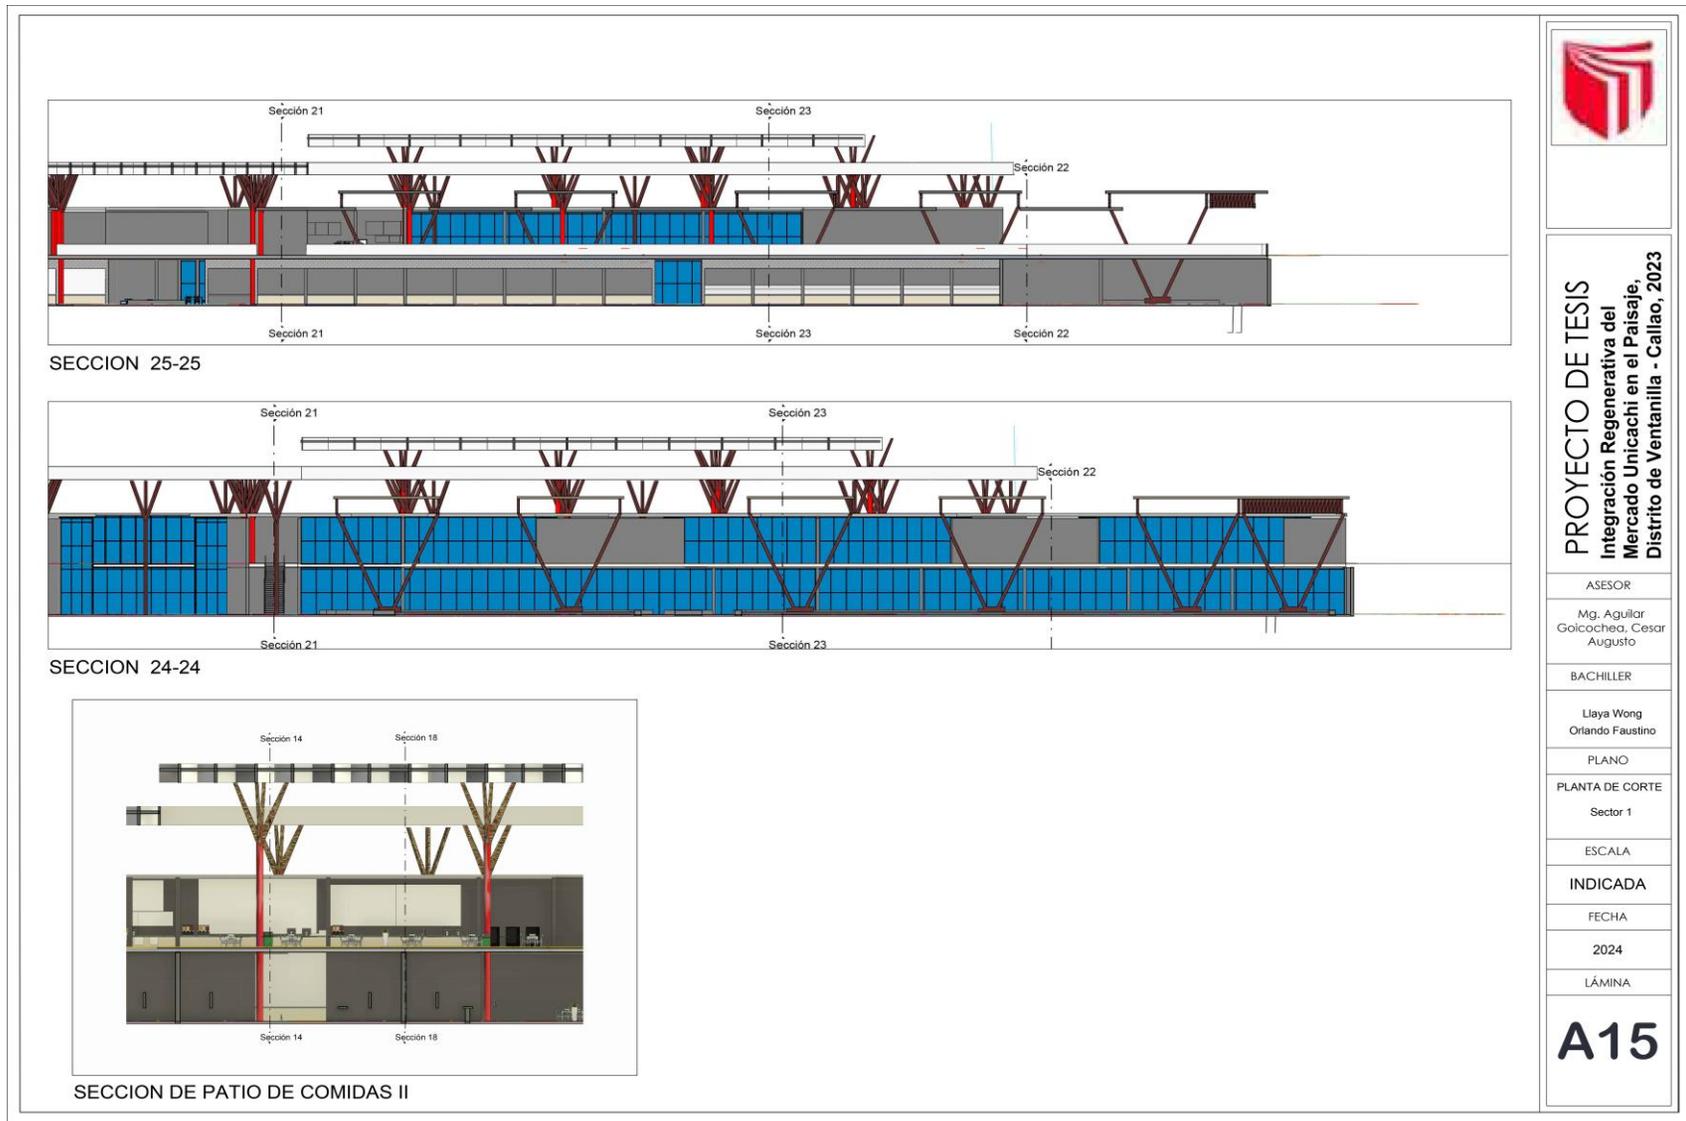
Plano de Cortes elevaciones de sector I – Plano I, elaboración propia.
